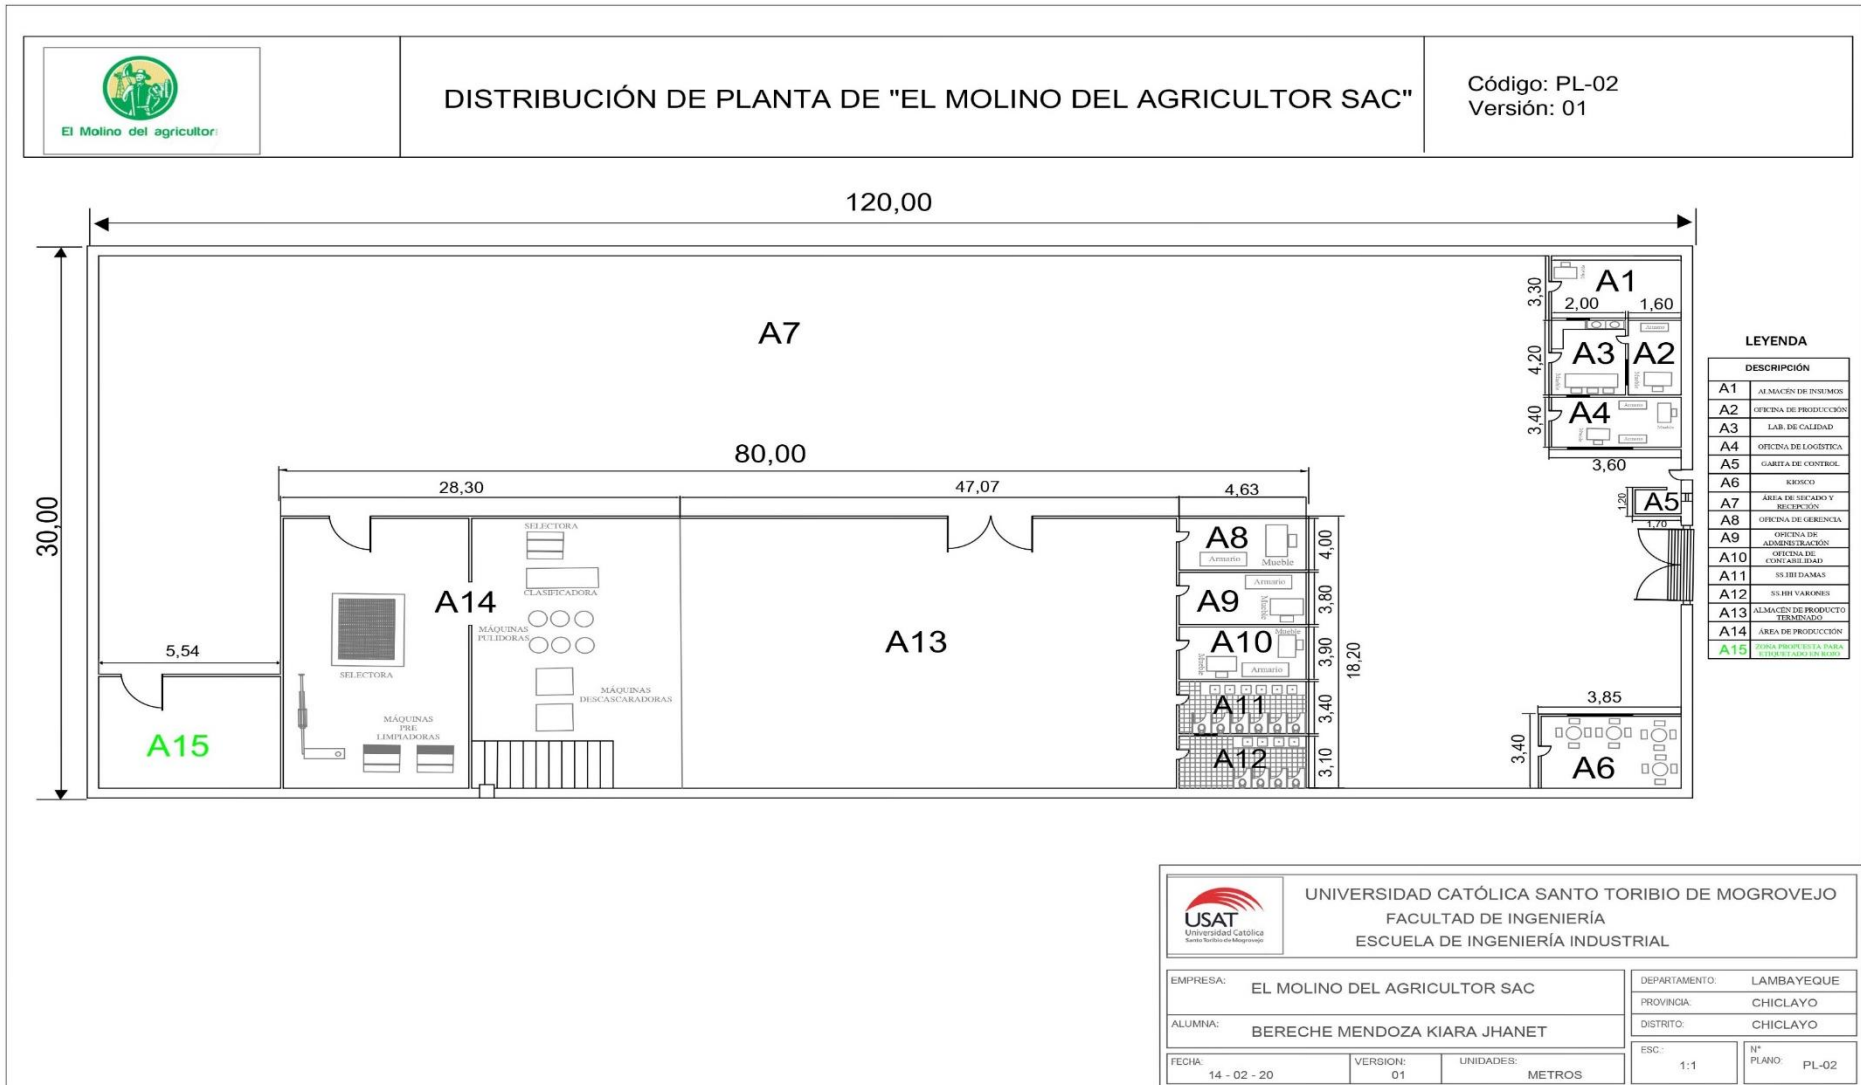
Distribución de planta de la empresa con la propuesta de zona etiquetado en rojo
